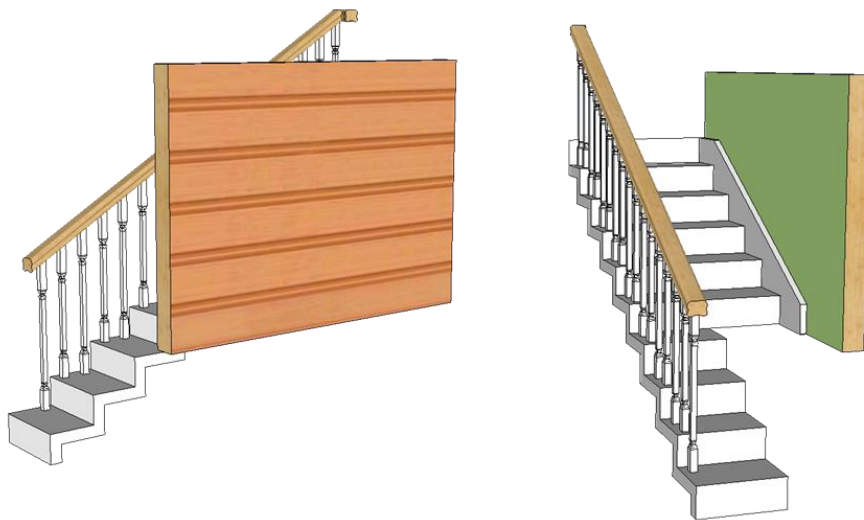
Bingo*. Perspectivas de la pieza central de la fachada junto a la escalera.
